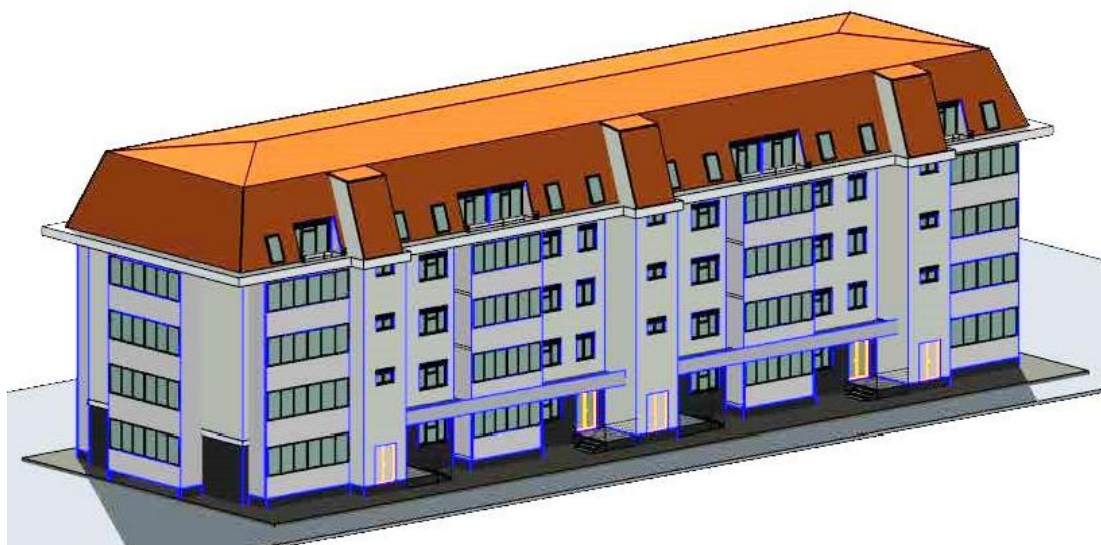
Фасад реконструируемого четырехэтажного здания
